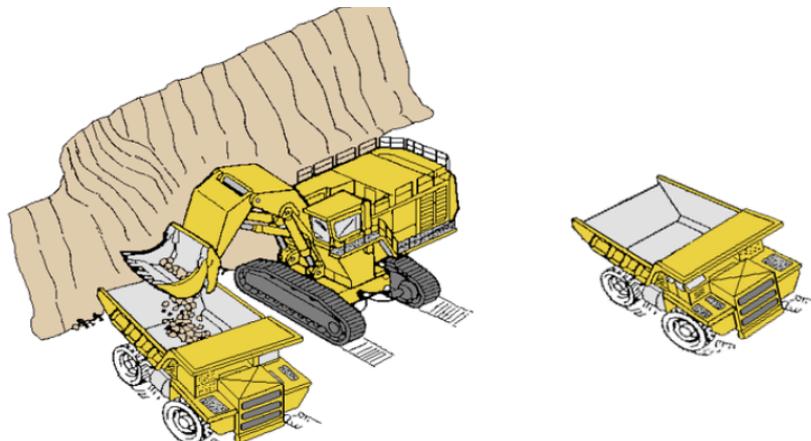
Exemplo de posicionamento correto entre caminhão e escavadeira.
